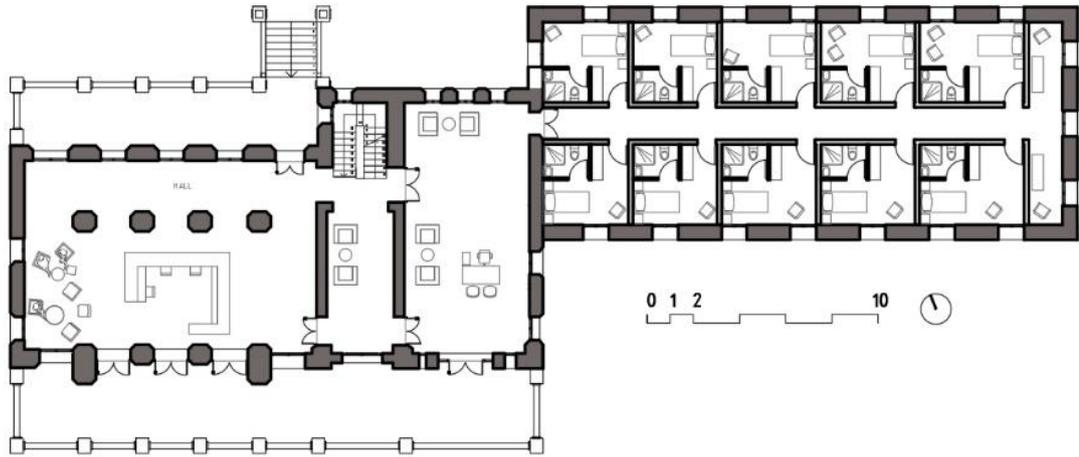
Hipótesis del Sanatorio de Cesuras, planta baja. Elaboración propia
